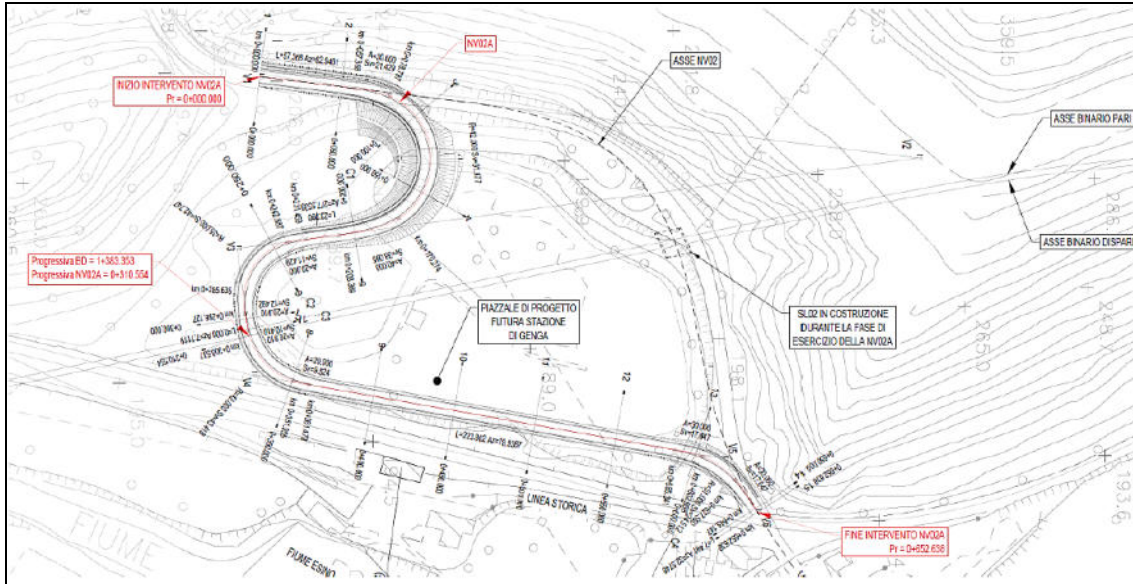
is Deviazione provvisoria via Marconi - Stralcio planimetrico
